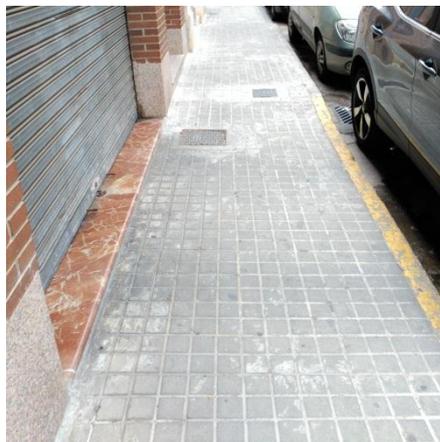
Pavimento antideslizante acera calle San Jerónimo
